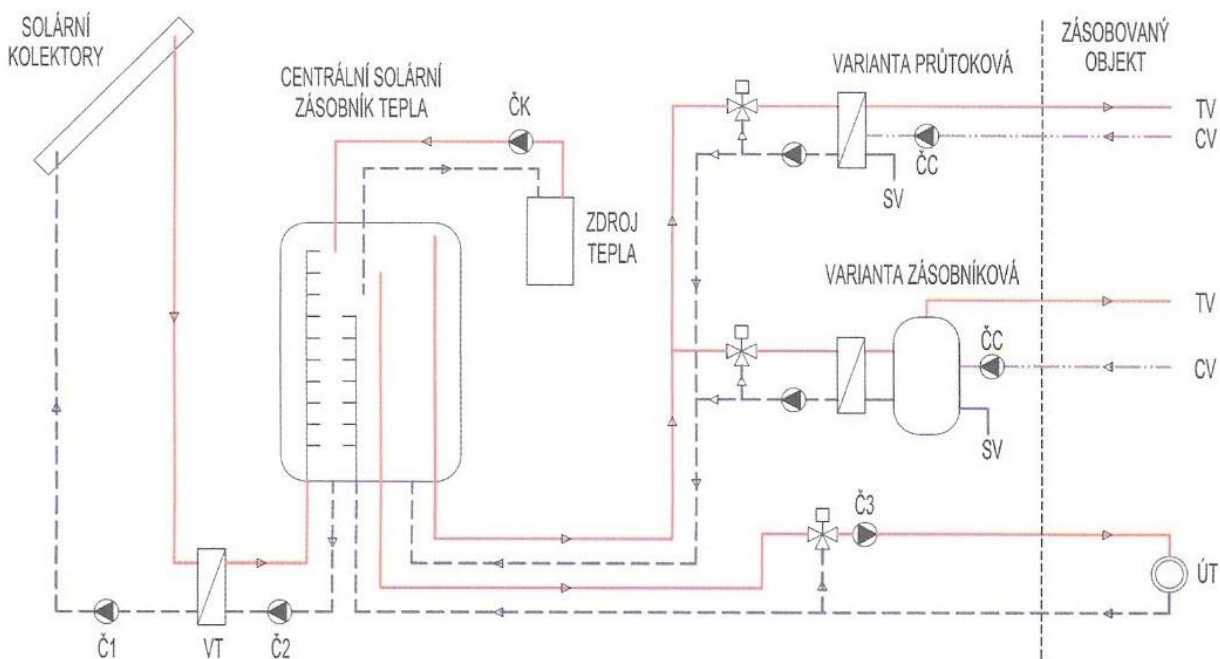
Příklad zapojení solární soustavy s centrálním kombinovaným zásobníkem, zdroj: Matuška T. - Solární soustavy v příkladech
